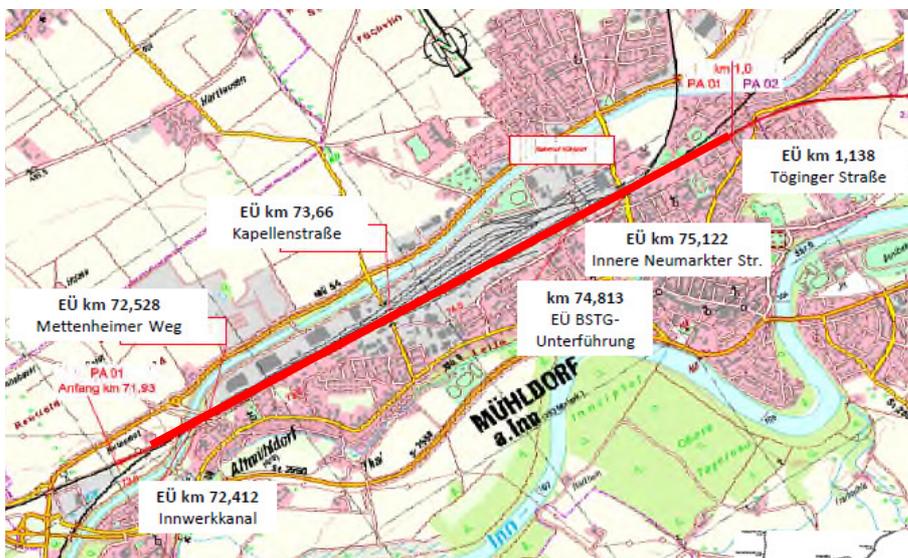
Lageplan Baufeld, Bahnhof Mühldorf
